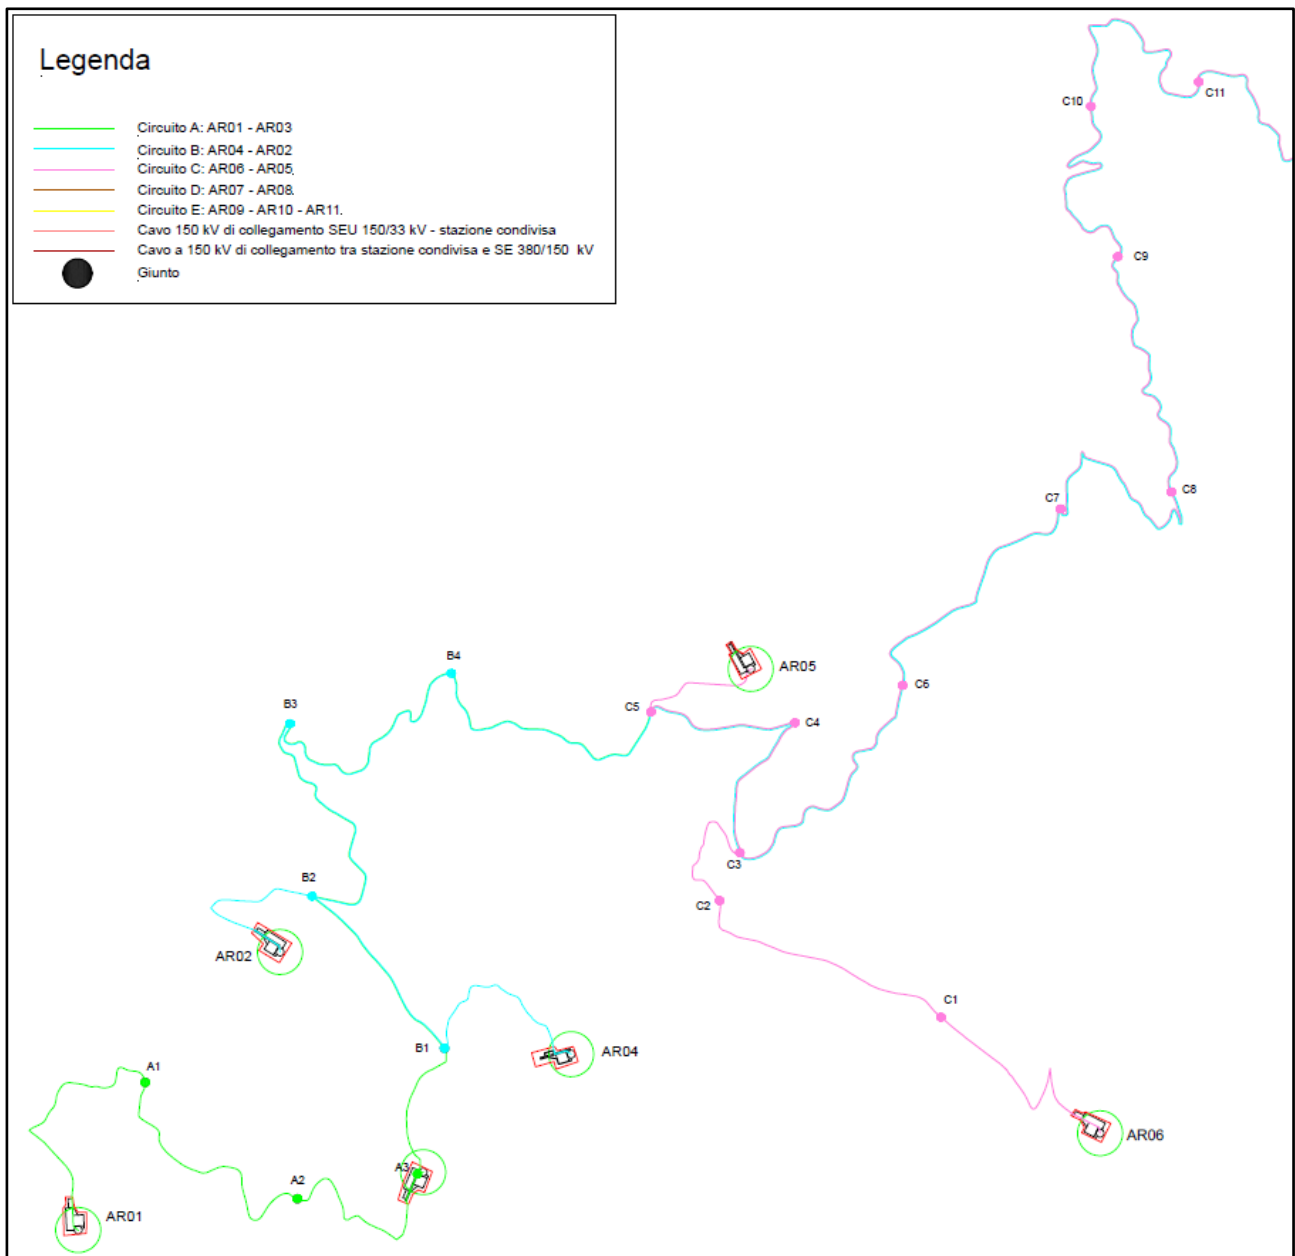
Dettaglio 1 - planimetria di distribuzione linee a 33 kV di collegamento
